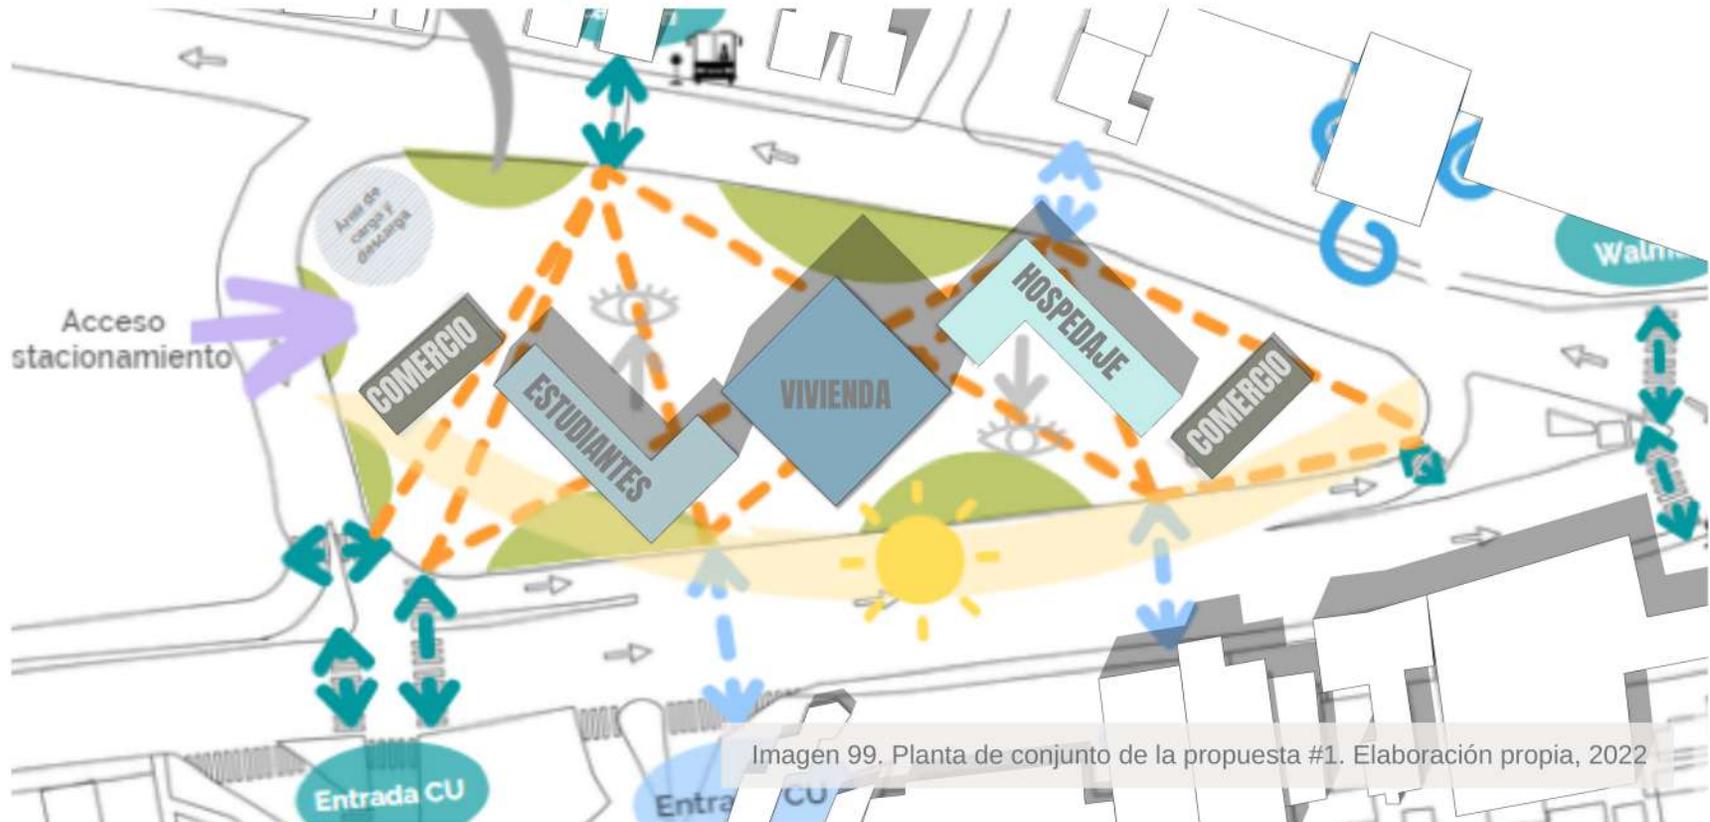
Planta de conjunto de la propuesta #1. Elaboración propia, 2022
